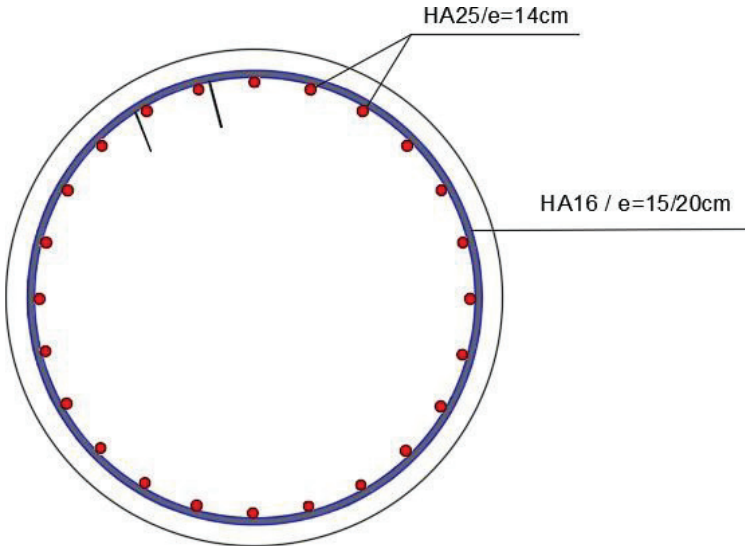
Croquis de ferrailage des pieux sur piles.
